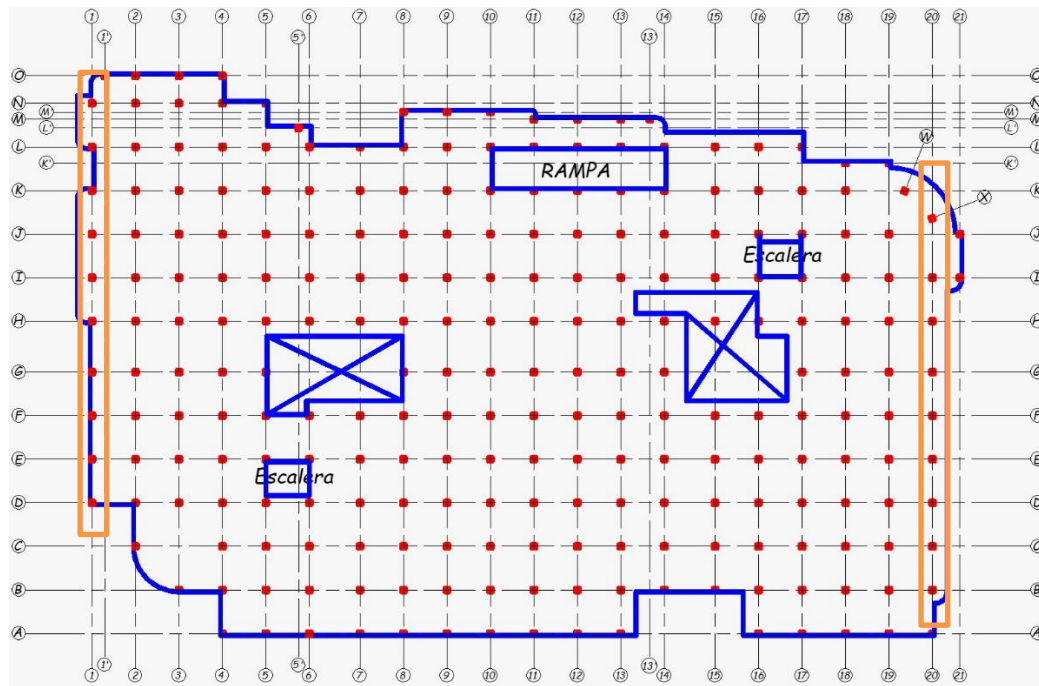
Ejes reforzados, vista en planta. Fuente: propia
